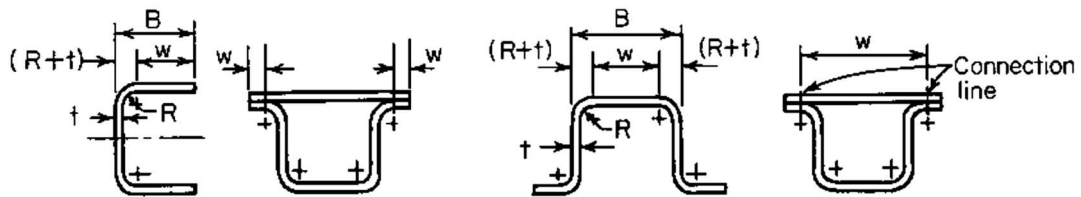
Ancho plano en elementos (izq.) no atiesados y (der.) atiesados. [4]
